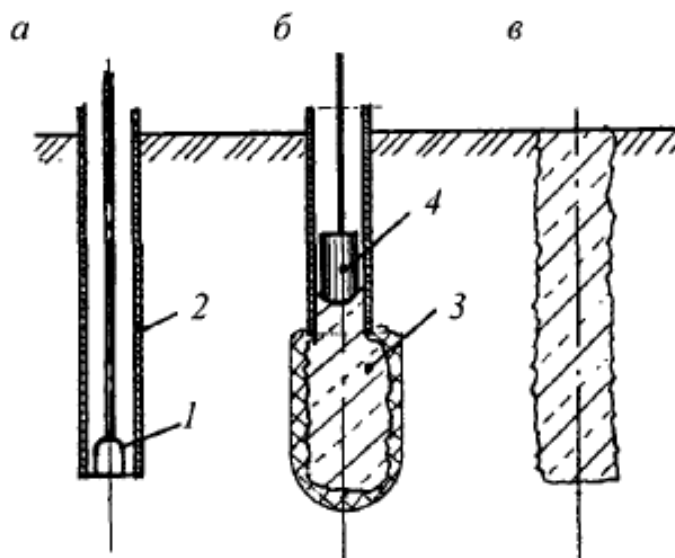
Последовательность изготовления буронабивной сваи (сваи Страуса): а бурение скважины под защитой обсадной трубы; б - бетонирование с трамбованием; в готовая свая: 1 - разбуриватель со штангой; 2 - обсадная труба; 3 - бетон; 4 - падающий груз
